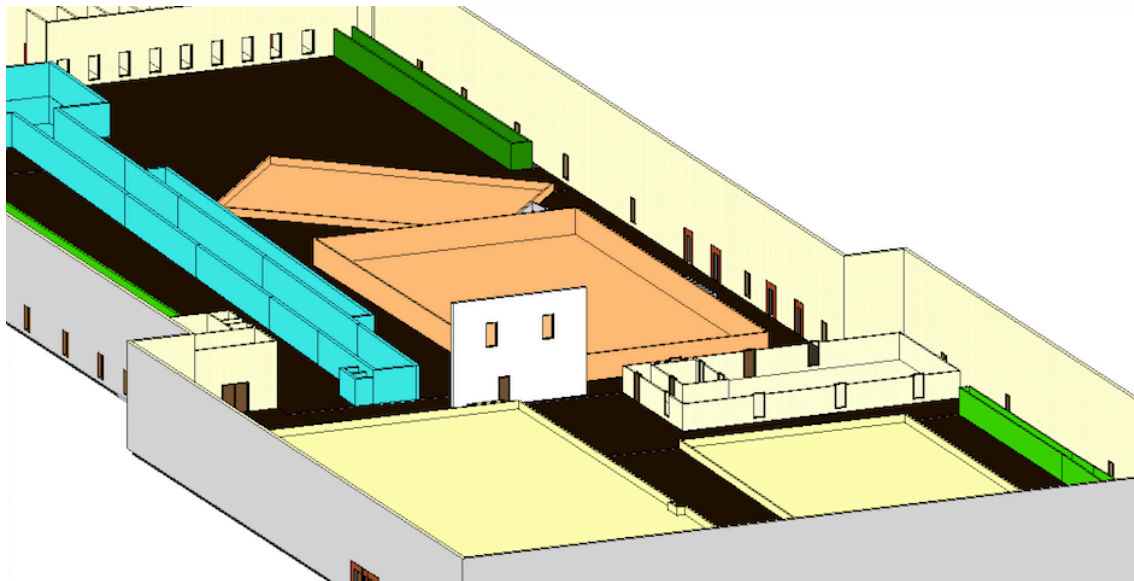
Modelo de Arquitetura da instalação – vista interior zonas A e B _ 1
